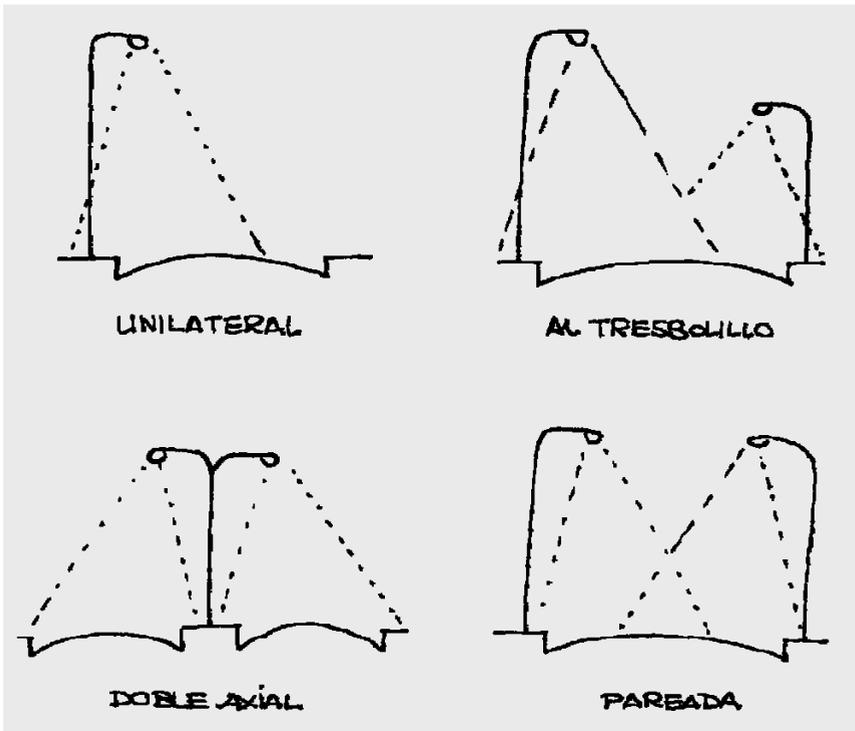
Disposiciones genéricas del alumbrado vial
